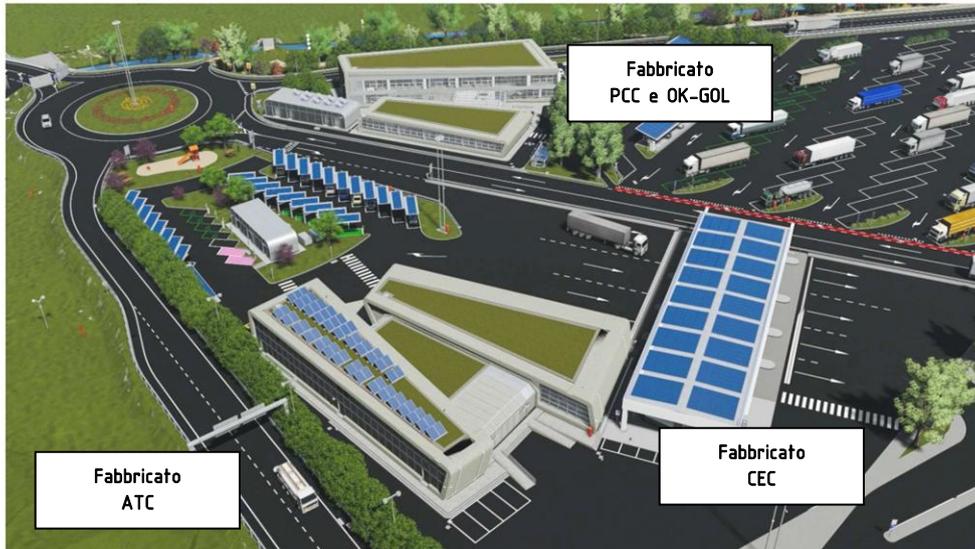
Planimetria dell'aeroporto e indicazione dei fabbricati
